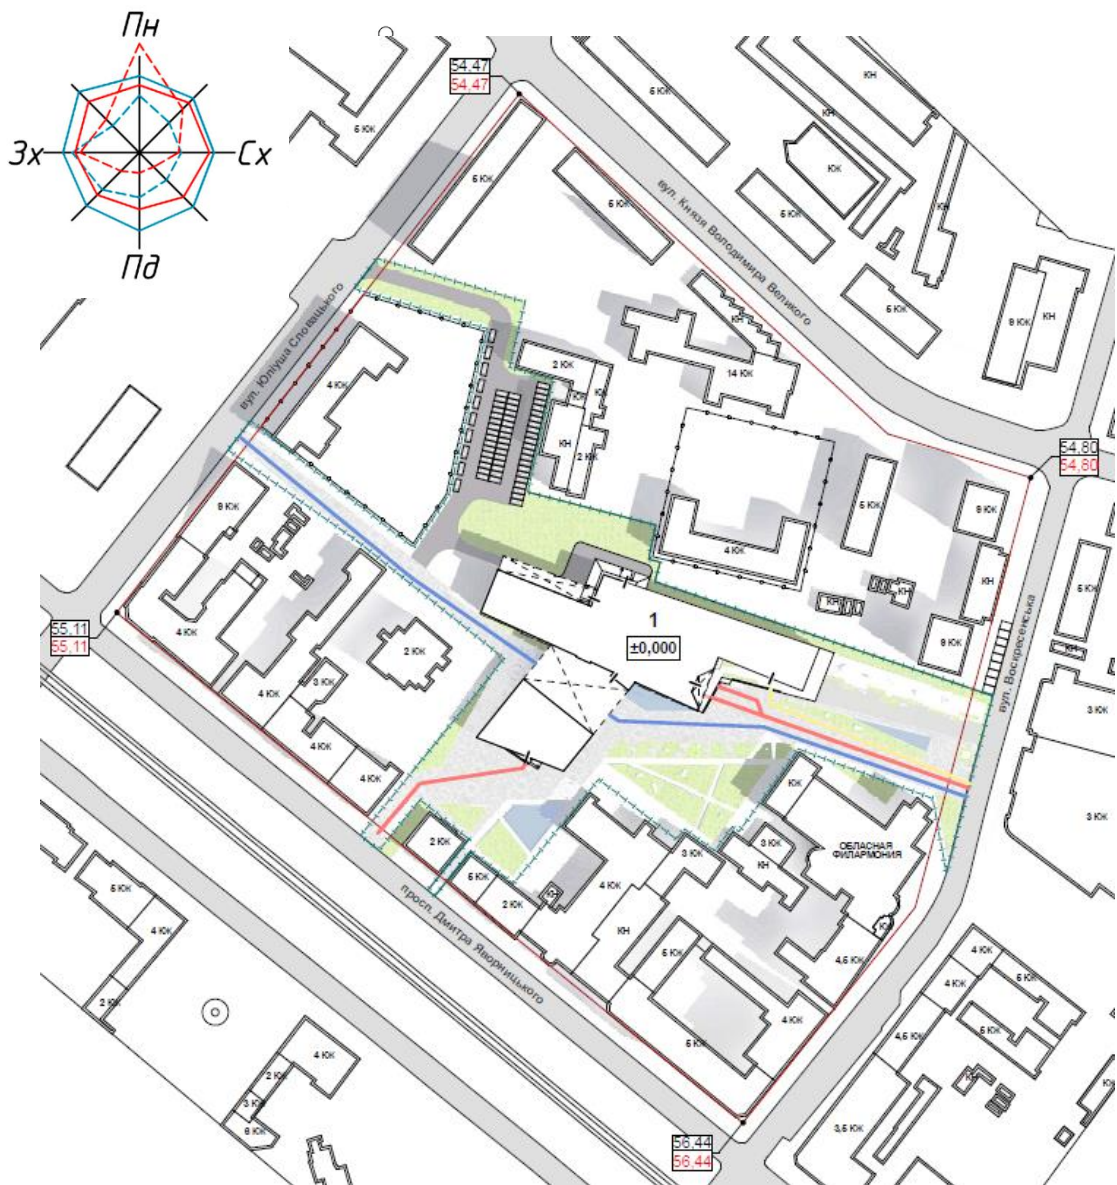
Генеральний план будівлі орієнтована по сторонах світу.
